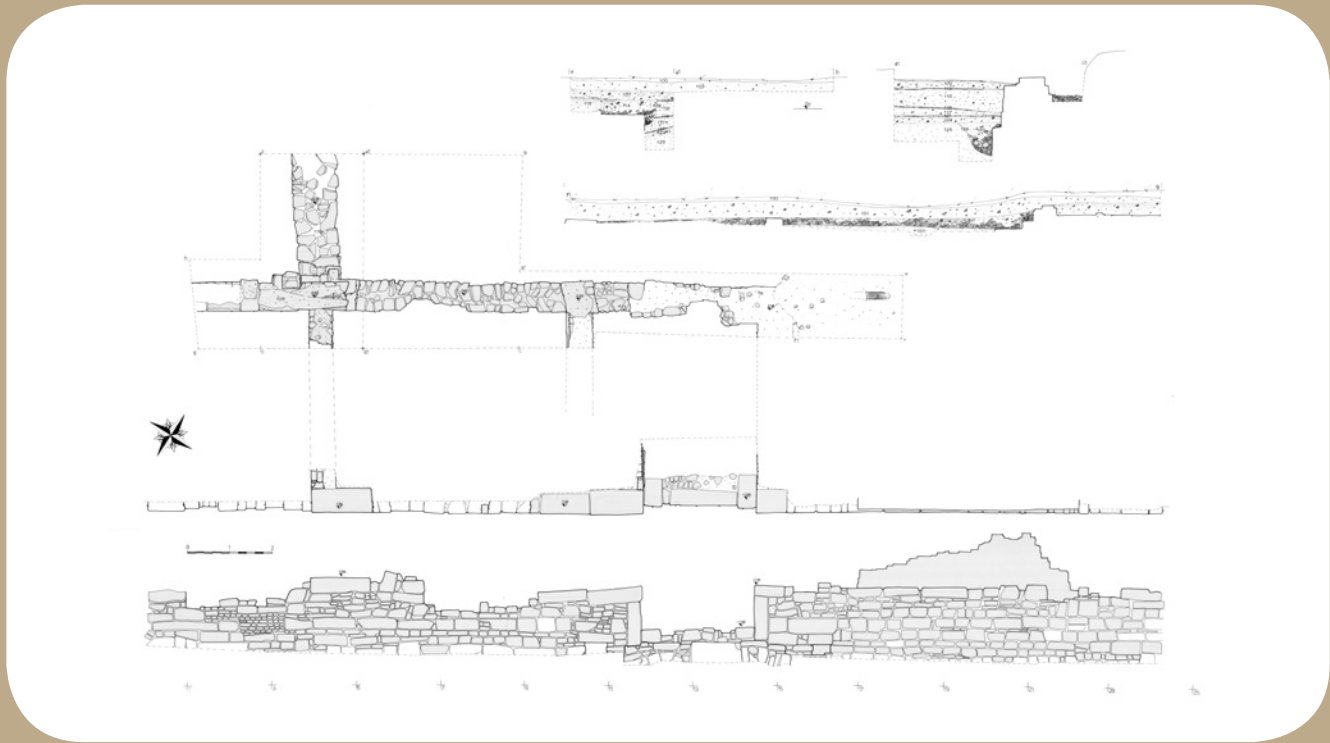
,3 - Pianta e prospetto occidentale dell'edificio scavato in contrada sant'Andrea
